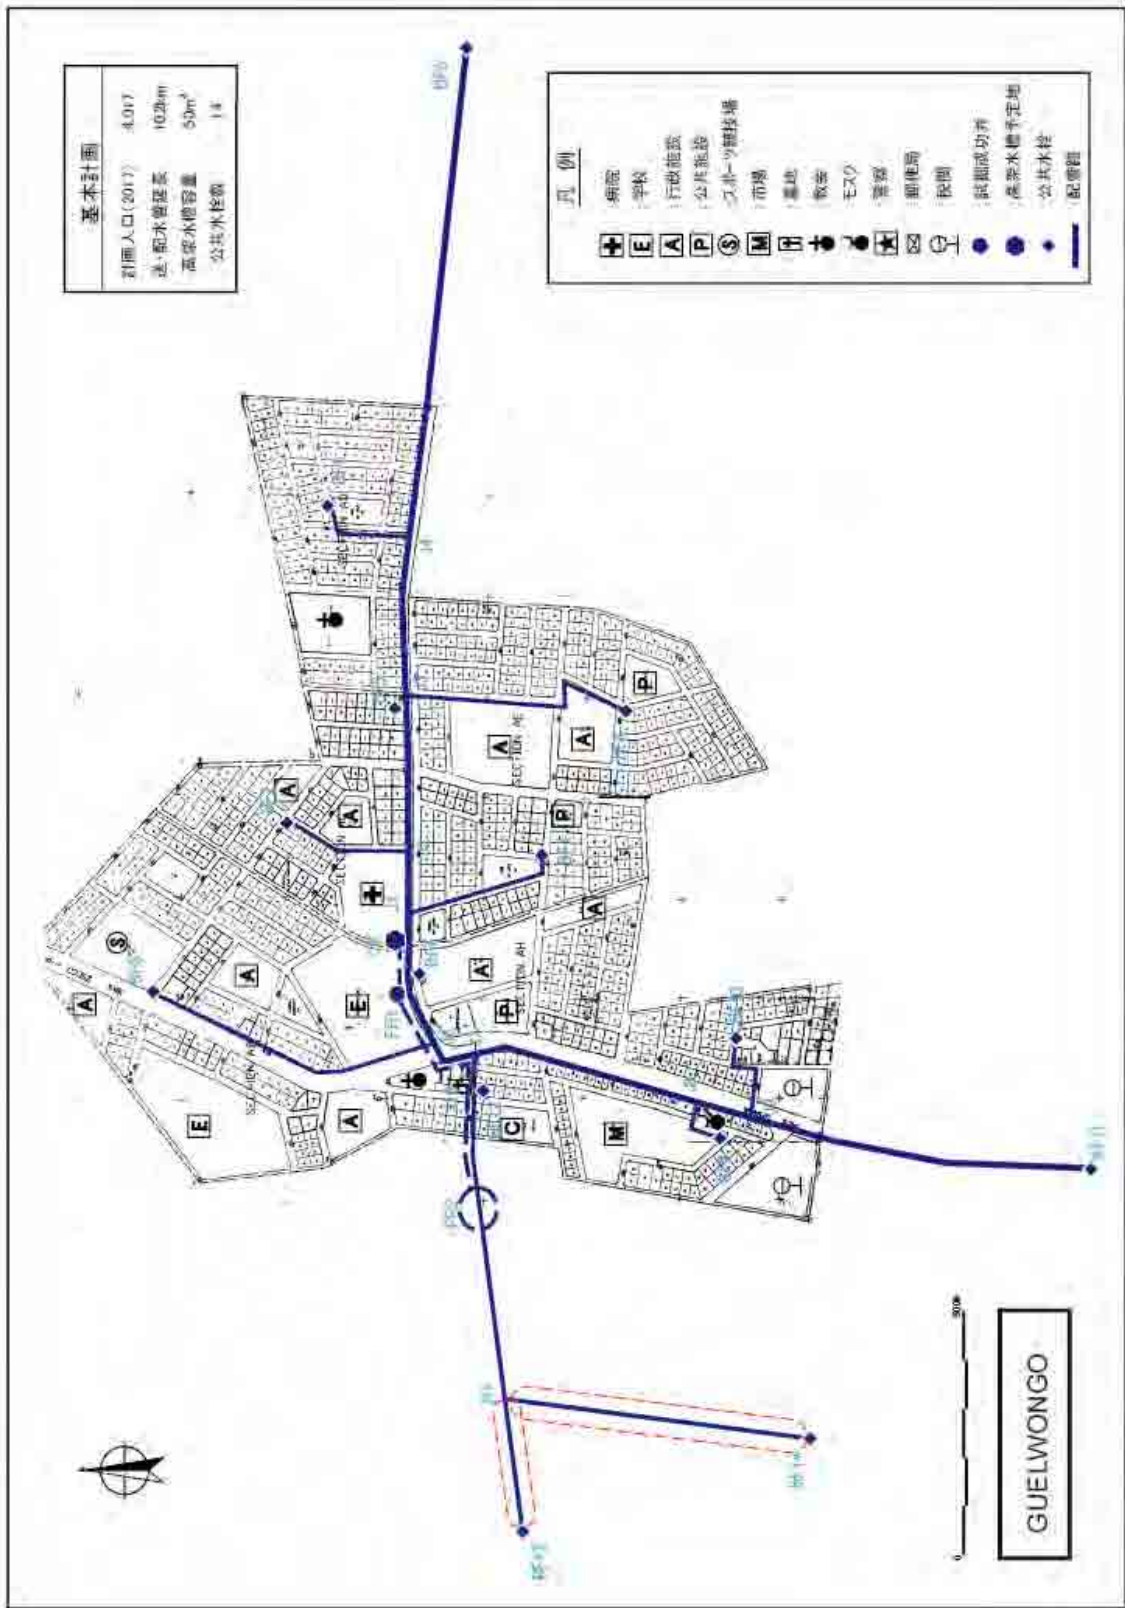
計画対象サイト(Guelwongo)の給水施設平面図
